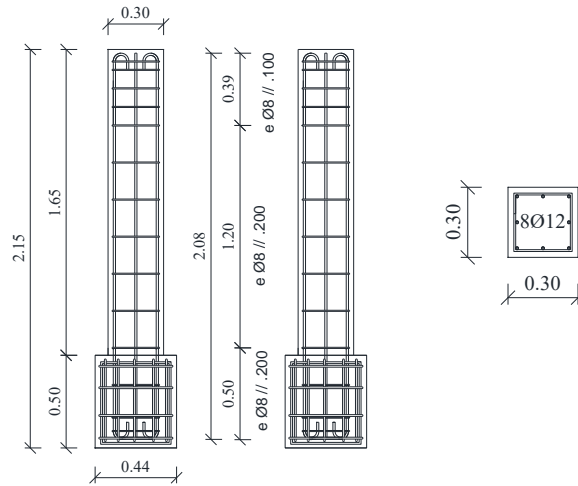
Dimensões e pormenorização das armaduras nos pilares com armadura lisa.
